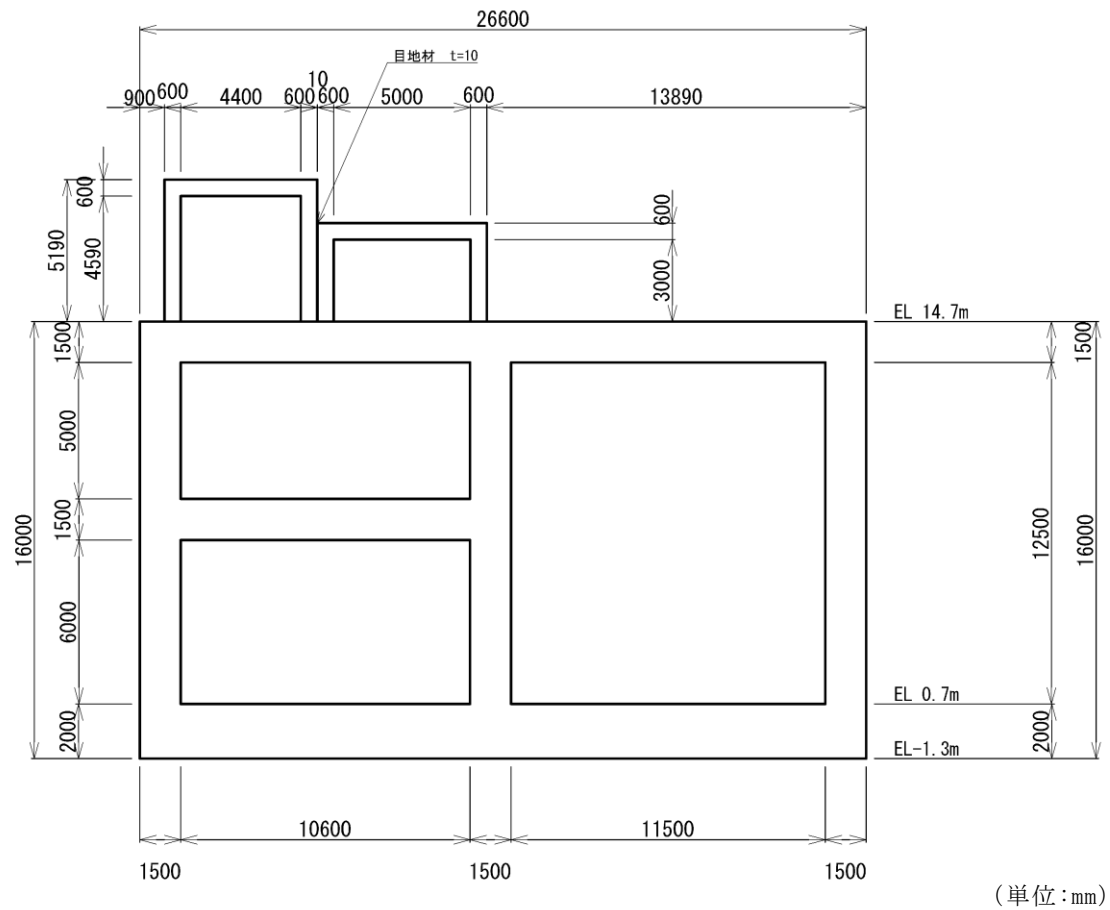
低圧原子炉代替注水ポンプ格納槽 断面図 (C-C 断面)
